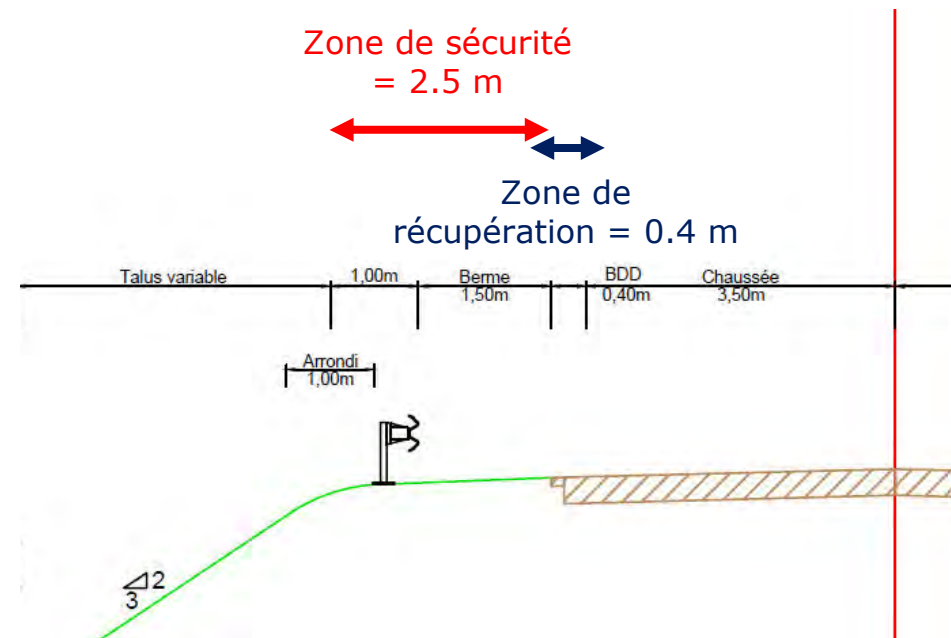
Profil en travers type étroit (extrait du cahier de profils en travers type)
